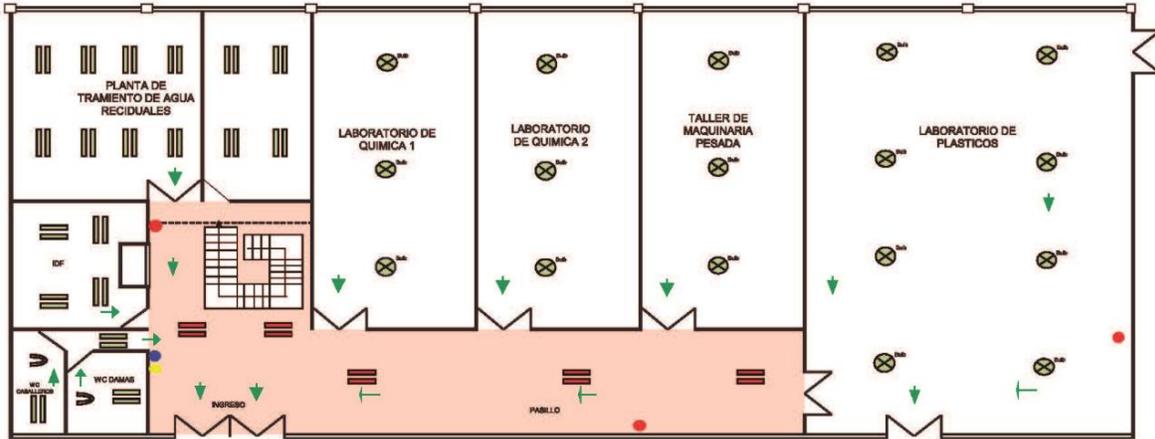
Edificio Taller Pesado “E”, Planta Baja
